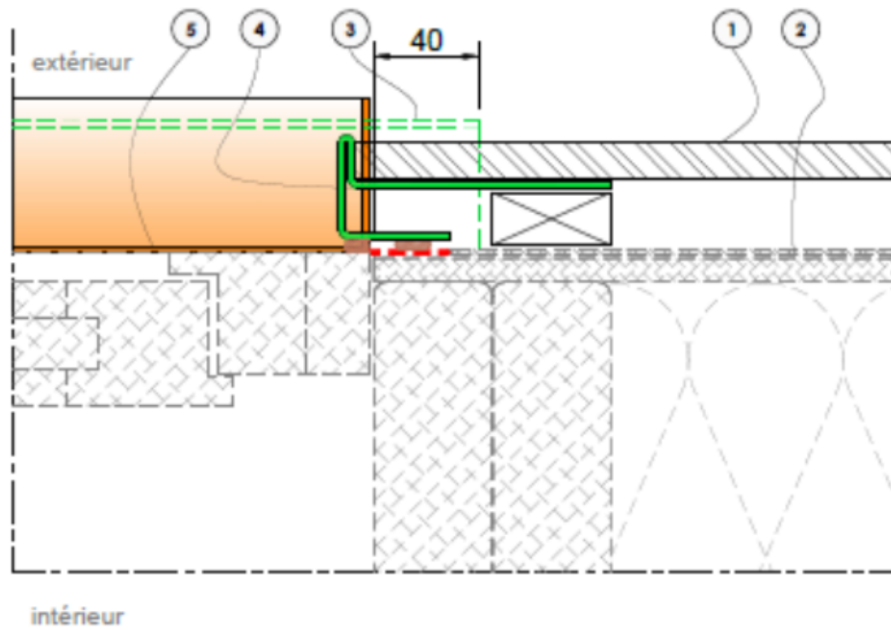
Menuiserie en tunnel extérieur – Coupe sur linteau de baie
